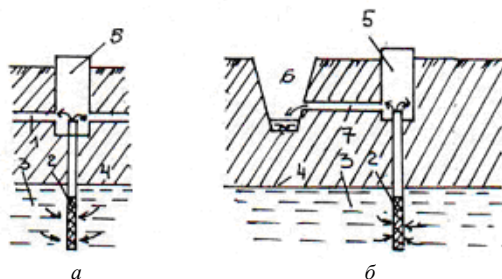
Конструкция ловчих дрен с вертикальными самоизливающимися колодцами: *а* – с закрытой ловчей дреной; *б* – в сочетании с открытым ловчим каналом; 1 – закрытый коллектор (дрена); 2 – фильтр самоизливающийся скважины (колодца); 3 – водоносный (напорный) пласт; 4 – слабопроницаемый слой; 5 – колодец; 6 – открытый канал; 7 – сбросная труба
